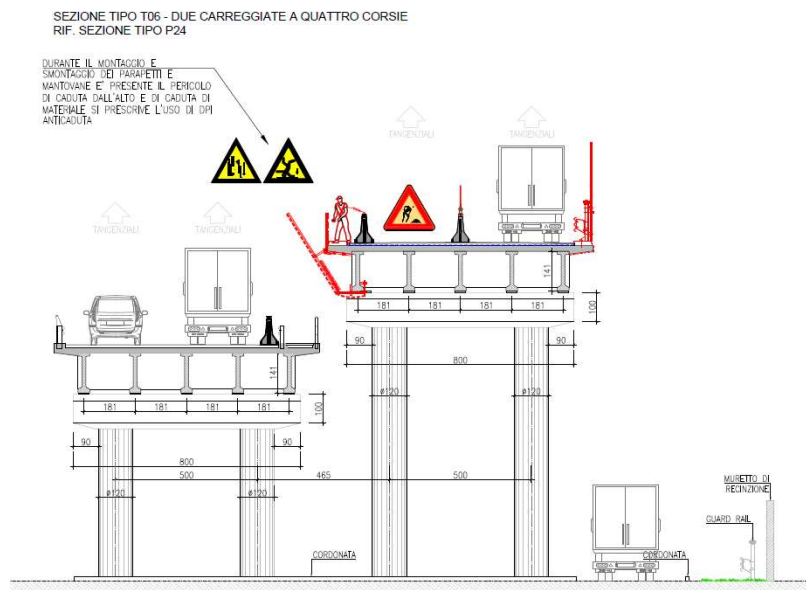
Sezione tipo di cantierizzazione (FASE 2) in affiancamento a rampa discendente
